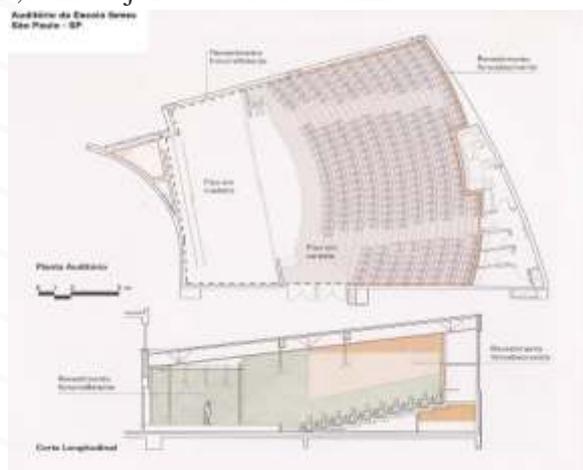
Planta baixa e corte do Auditório da Escola Ibmecc
